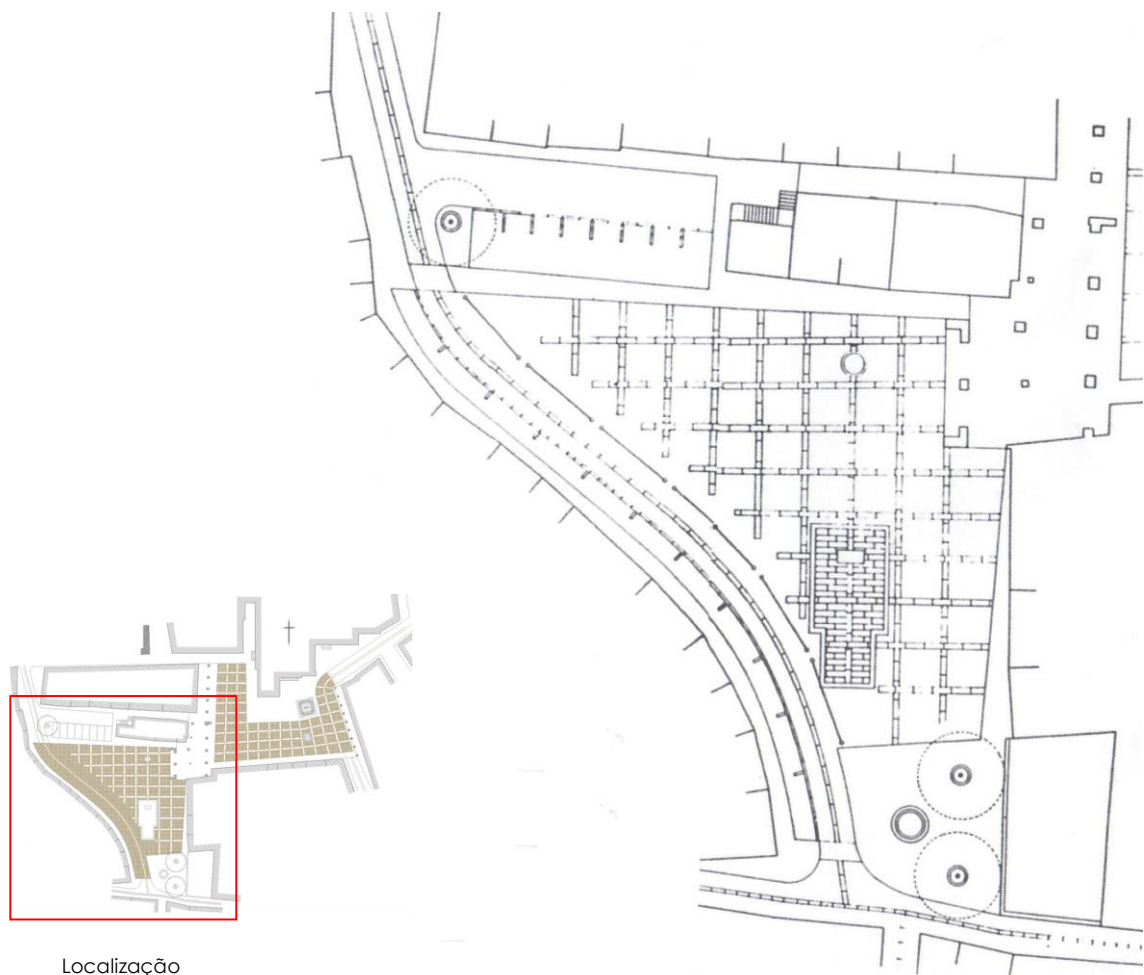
Planta da Praça de Santiago – intervenção do arquitecto Fernando Távora
